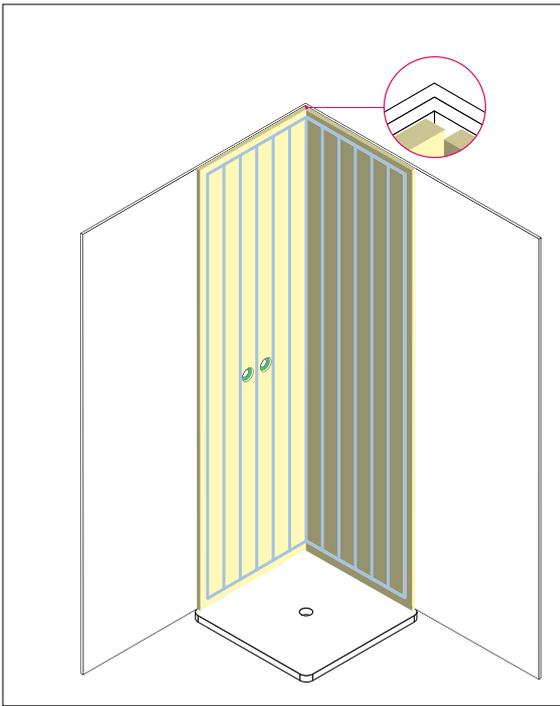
Giunti di espansione e fissaggio di RAUVISIO crystal slim alla parete
